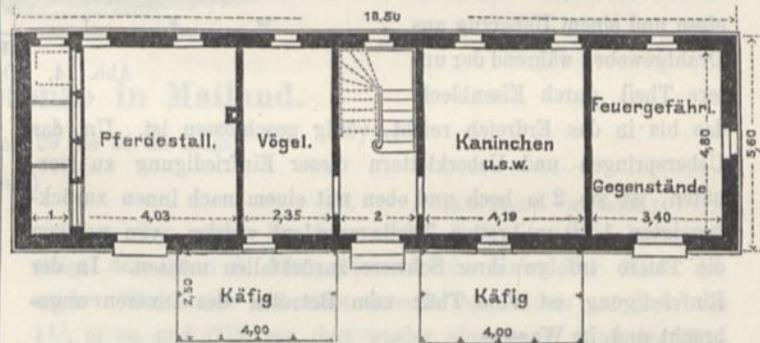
Erdgeschossgrundriss vom Nebengebäude.
